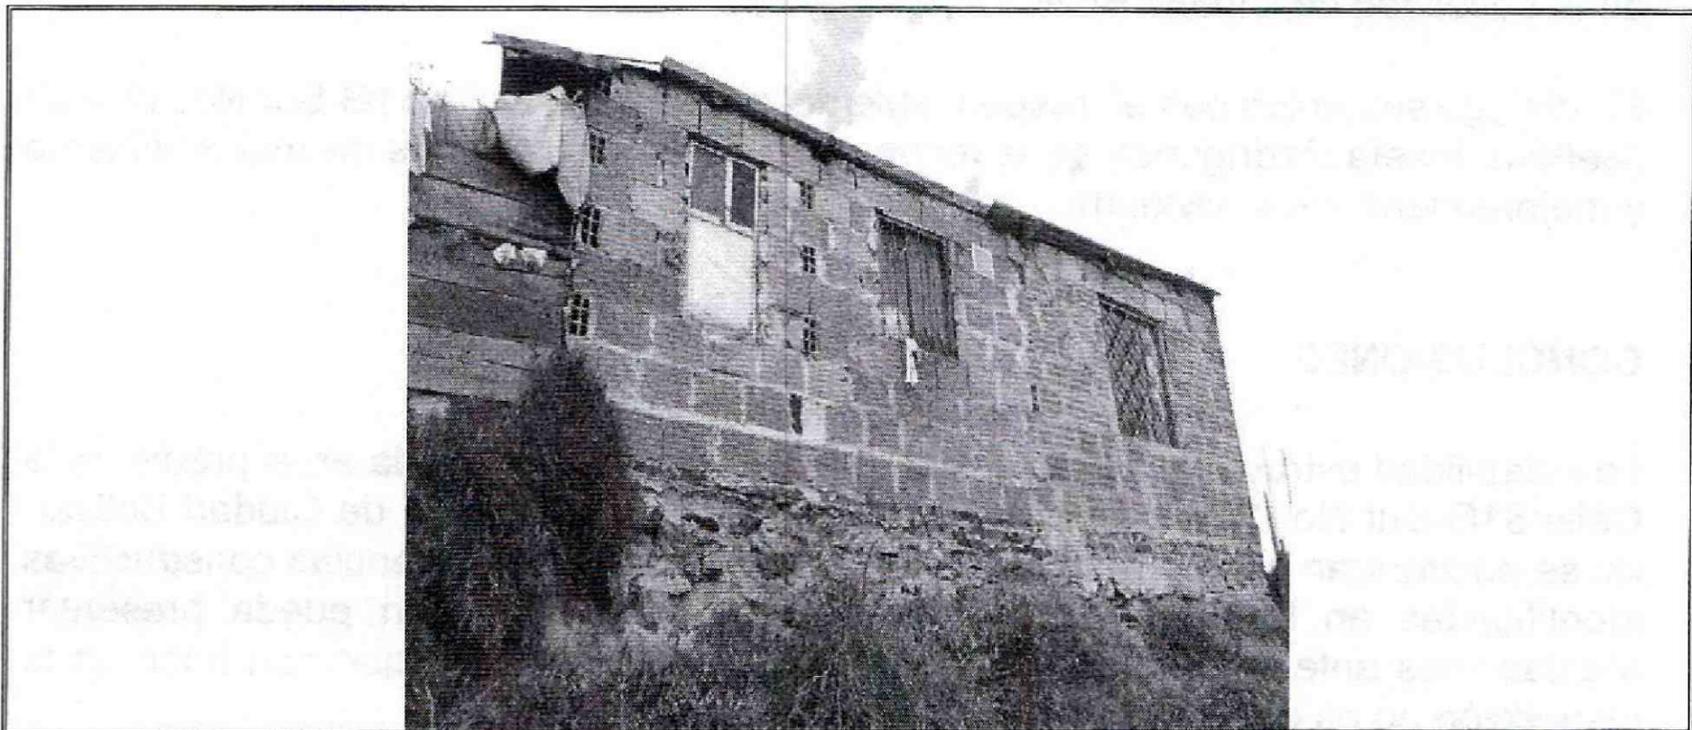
Talud de relleno y muro en piedra pegada, sobre el costado oriental de la vivienda evaluada.
